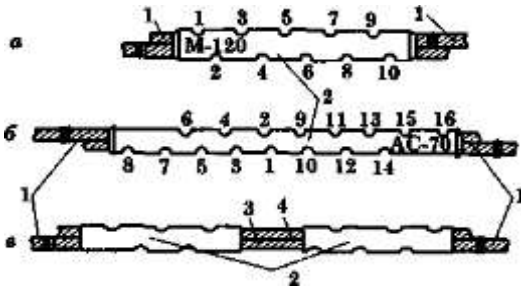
Соединение медных, алюминиевых, стальных (а) и сталеалюминиевых (б) проводов обжатием овального соединителя с применением термитной сварки (в): 1 — провод; 2 — овальный соединитель; 3 — место сварки проводов; 4 — унт
